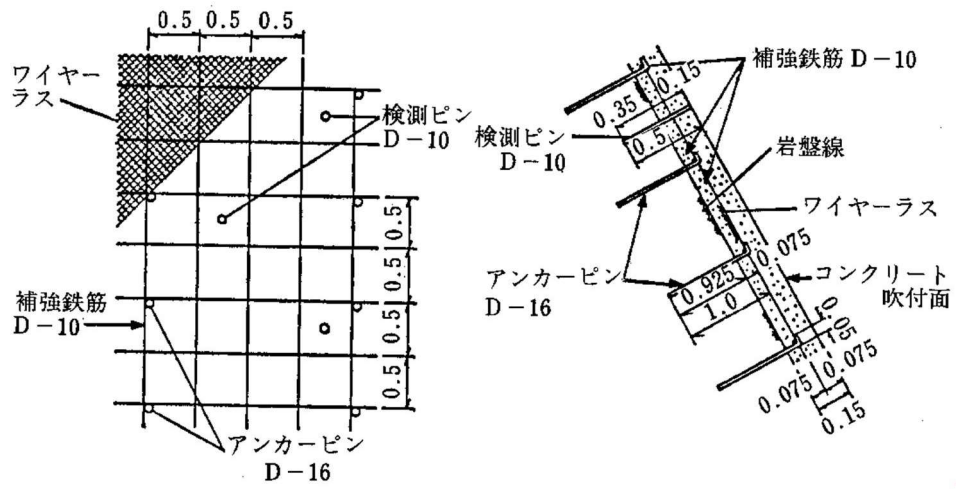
1 1 コンクリート吹付工の一例 (単位:m)
